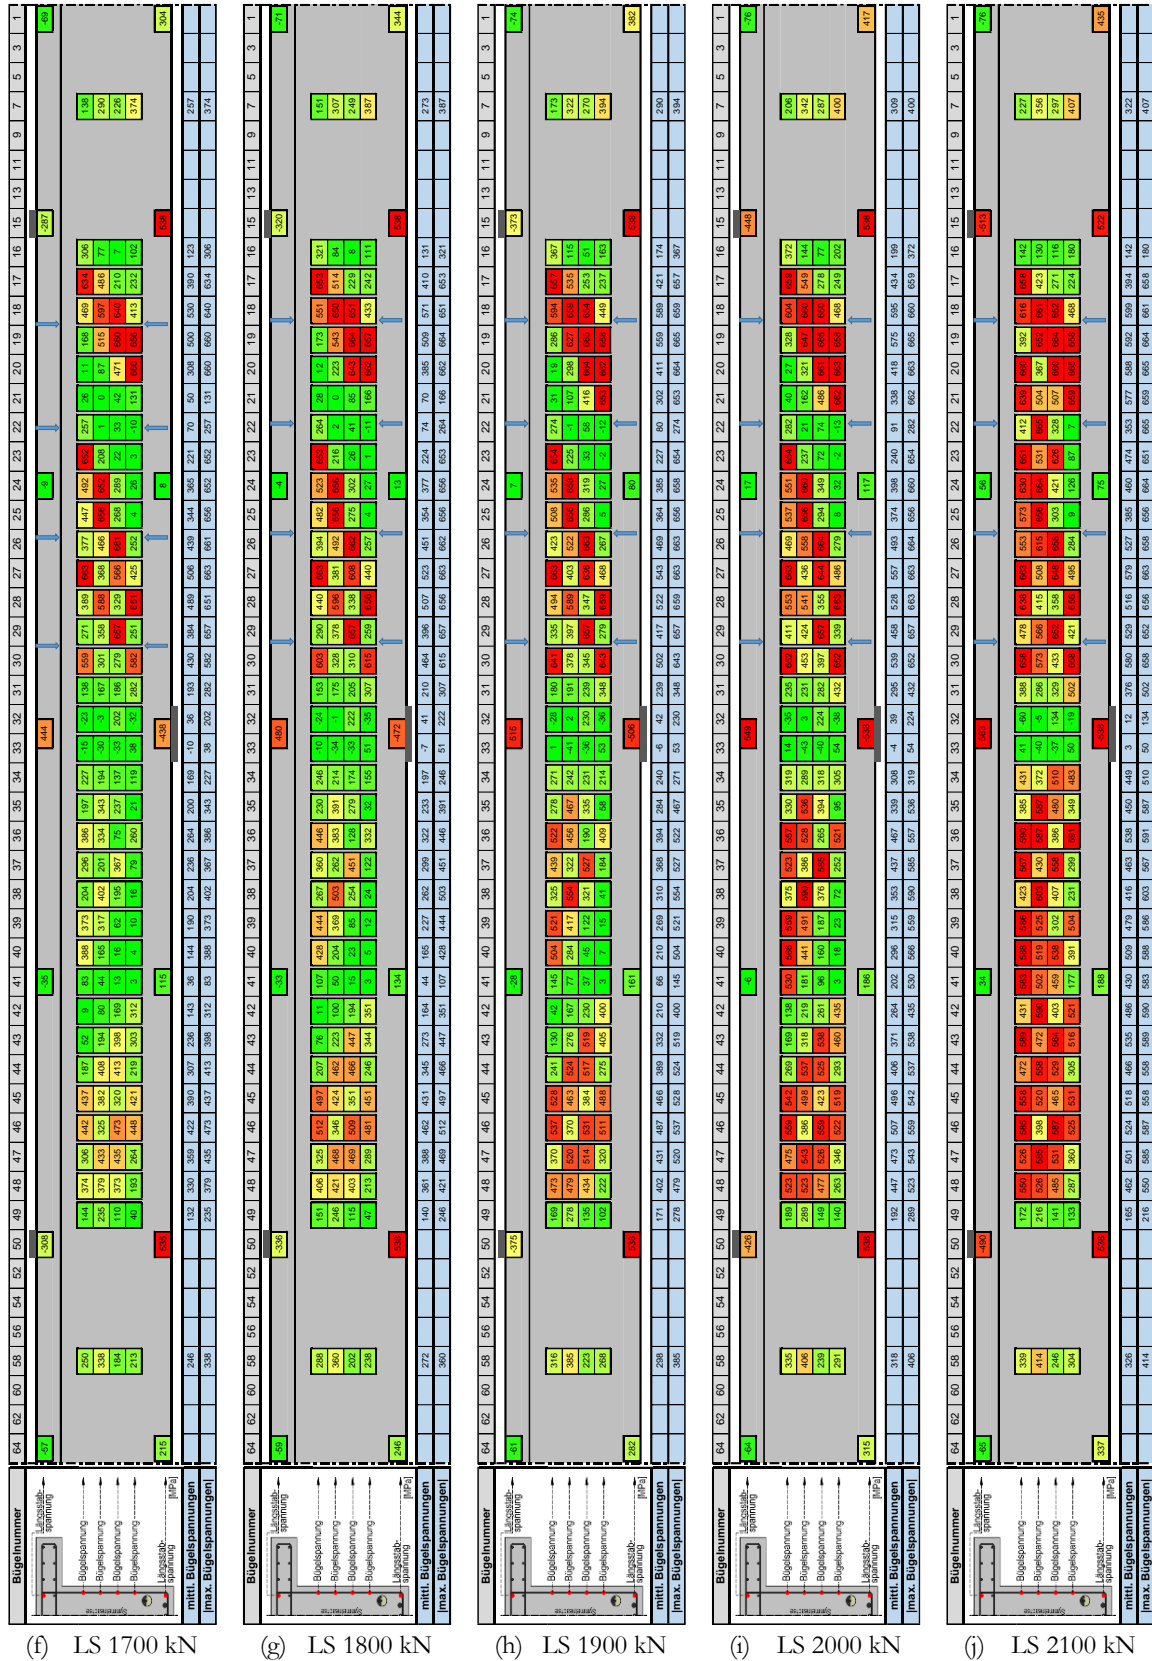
Betonstahlspannungen des Versuchsträgers DLT 2 für ausgewählte Laststufen, Teil 2
